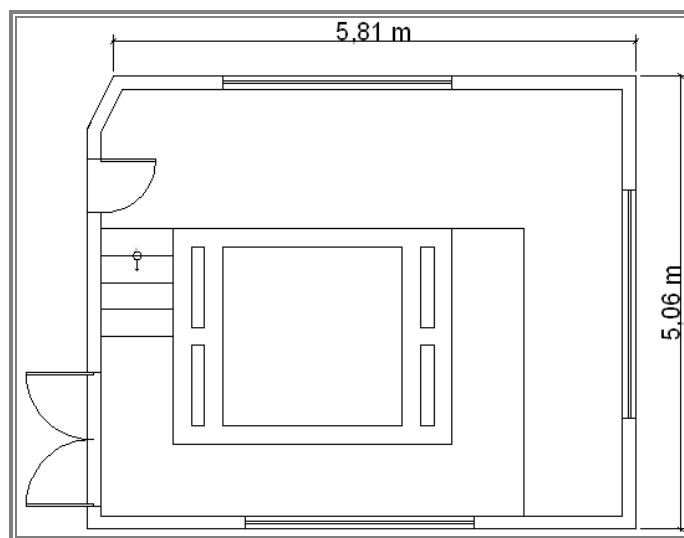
Planta baixa do tanque teste de pavimentos (sem escala) da COPPE/UFRJ (Bastos, 2010)
